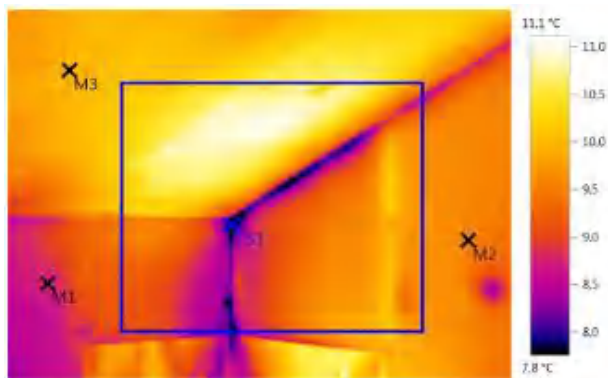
Термическое изображение угла помещения мансардного этажа / Thermal image of the corner room on attic floor
